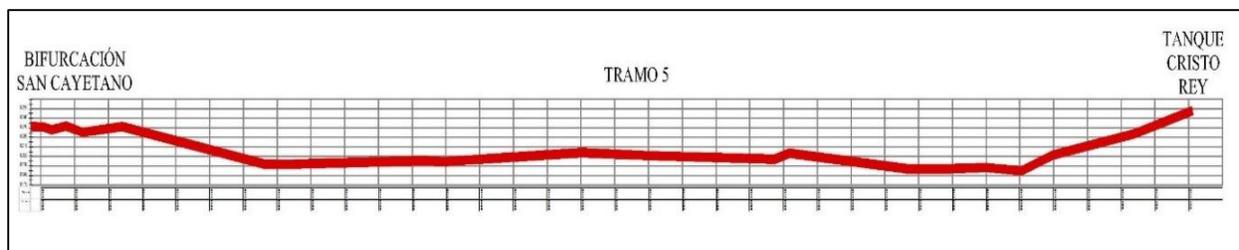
Perfil del terreno tramo bifurcación denominado San Cayetano-tanque Cristo Rey.
